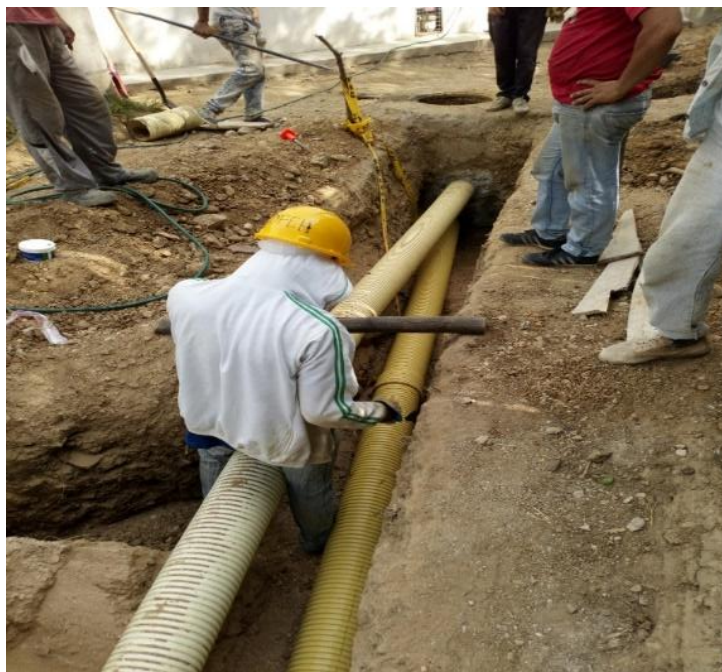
Retiro de tubería existente de alcantarillado sanitario de 0 a 12", Calle Jerusalén.
